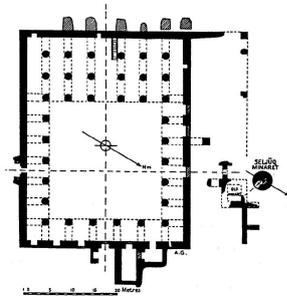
Târik-Hâna, Damghan, Grundriss nach Godard [23]
